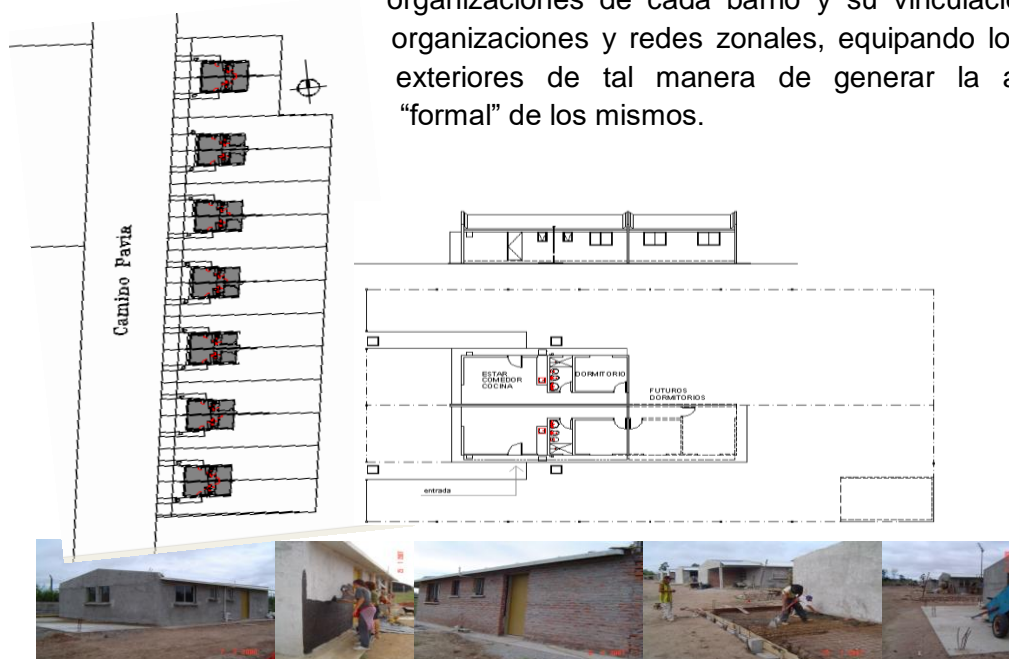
Complejo habitacional sobre el Camino Pavia: planta de ubicación, planta y alzado de la casa suministrados por el Servicio de Tierras y Viviendas de la IMM en el año 2006. Fotos del mismo barrio, de la autora, año 2006- 2007.
